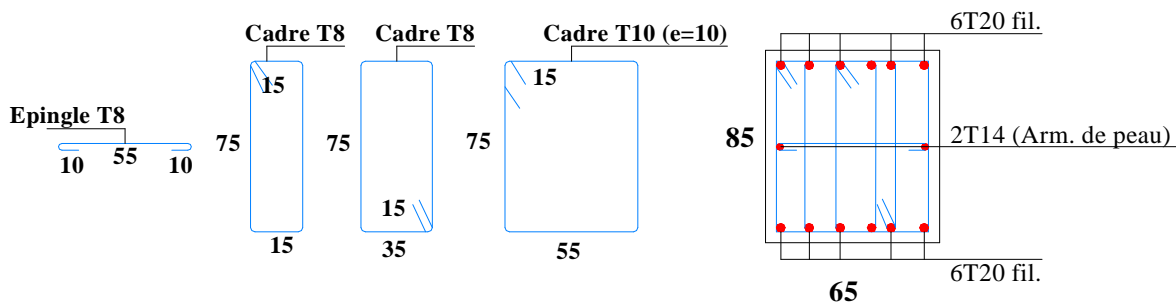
détails de ferrailage d'un appui de nervure.
